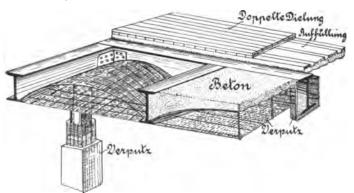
Gewölbte Decken nach Bauweise RÖBLING.
